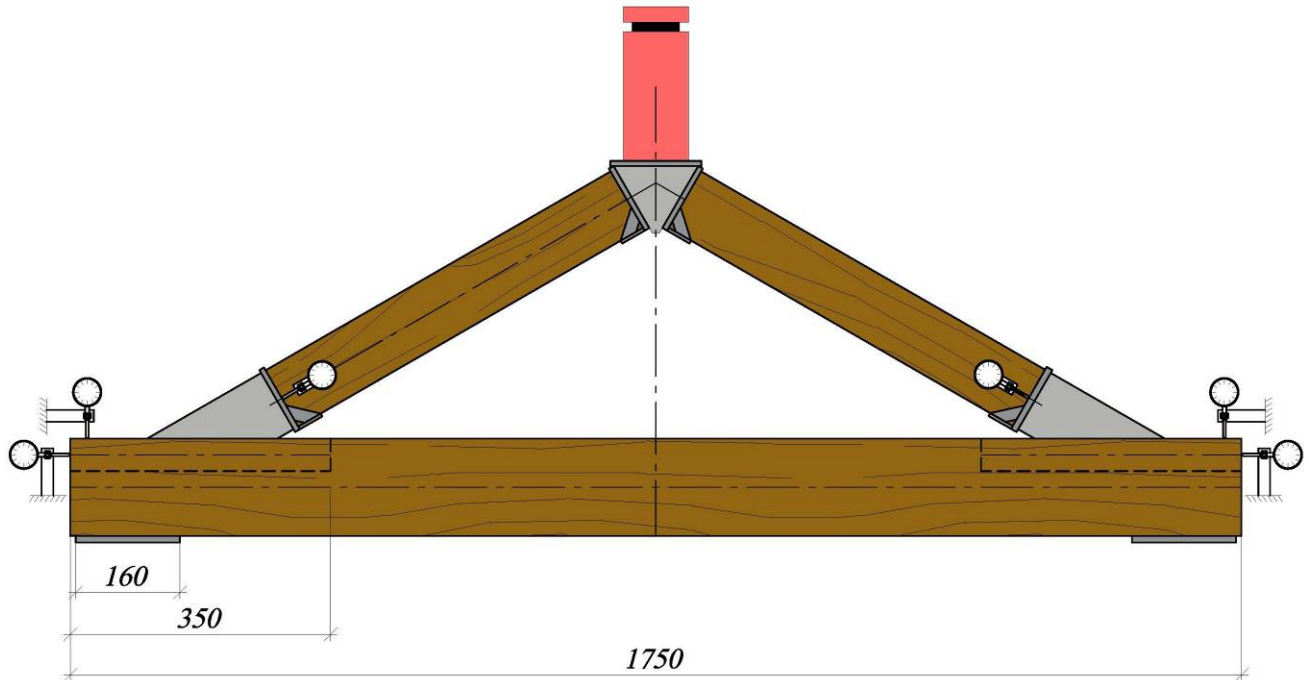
Схема испытательной установки для проведения экспериментальных исследований опорных узлов ферм с применением клеенных пластин
